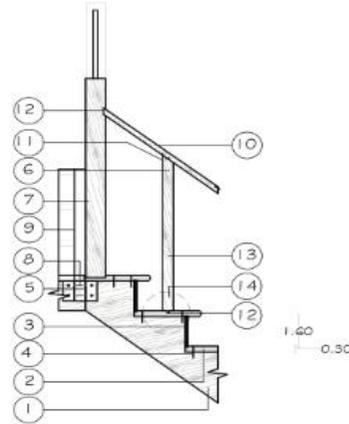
Detalle 1 Estructura de escalera interiores(Tipología 3)-Esc:1/20
